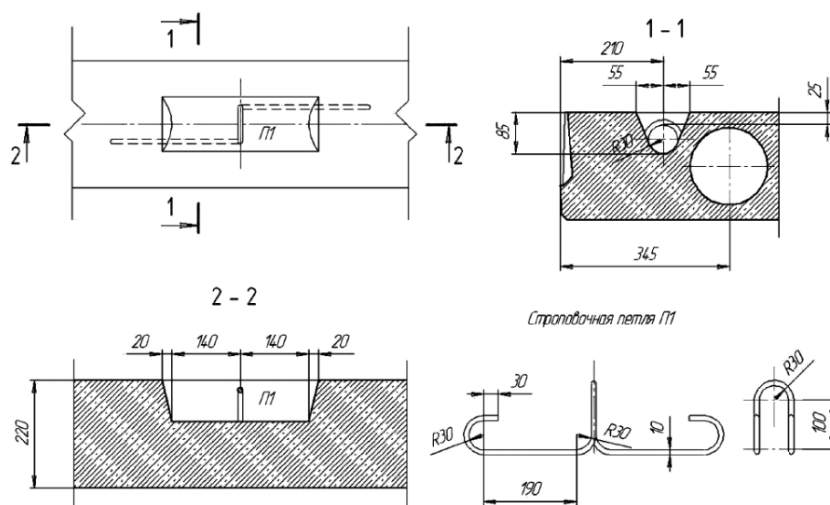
Конструктивные особенности строповочных петель многопустотной плиты перекрытия
